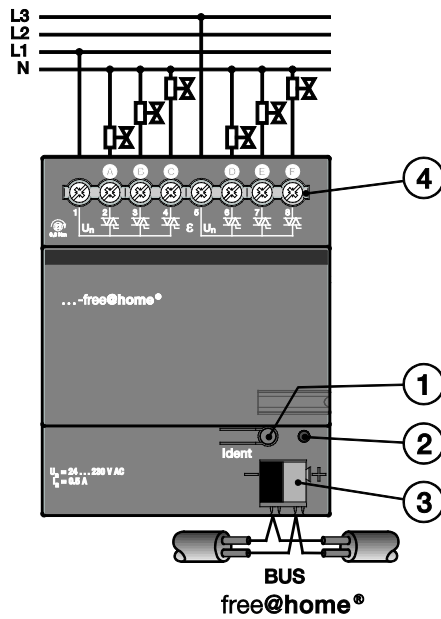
Vue d'ensemble de l'actionneur de chauffage sextuple
